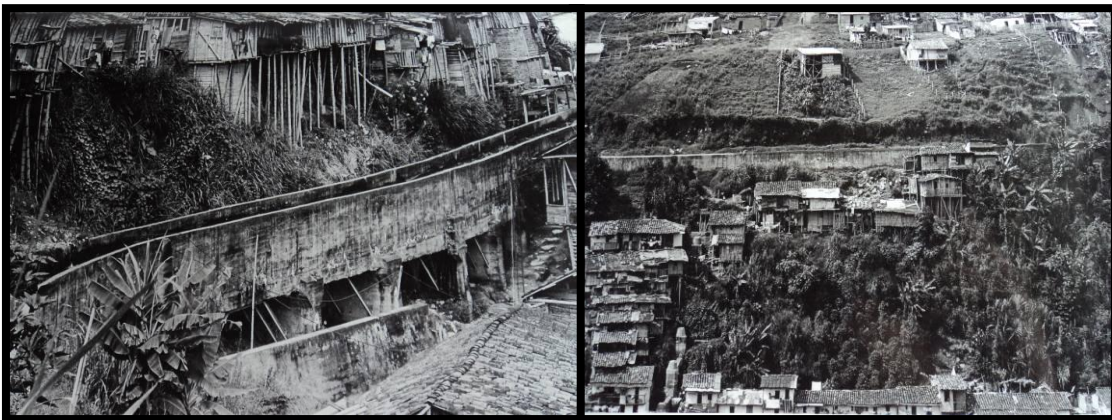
y 8 Viviendas construidas en cercanía al canal de conducción de Dosquebradas.
